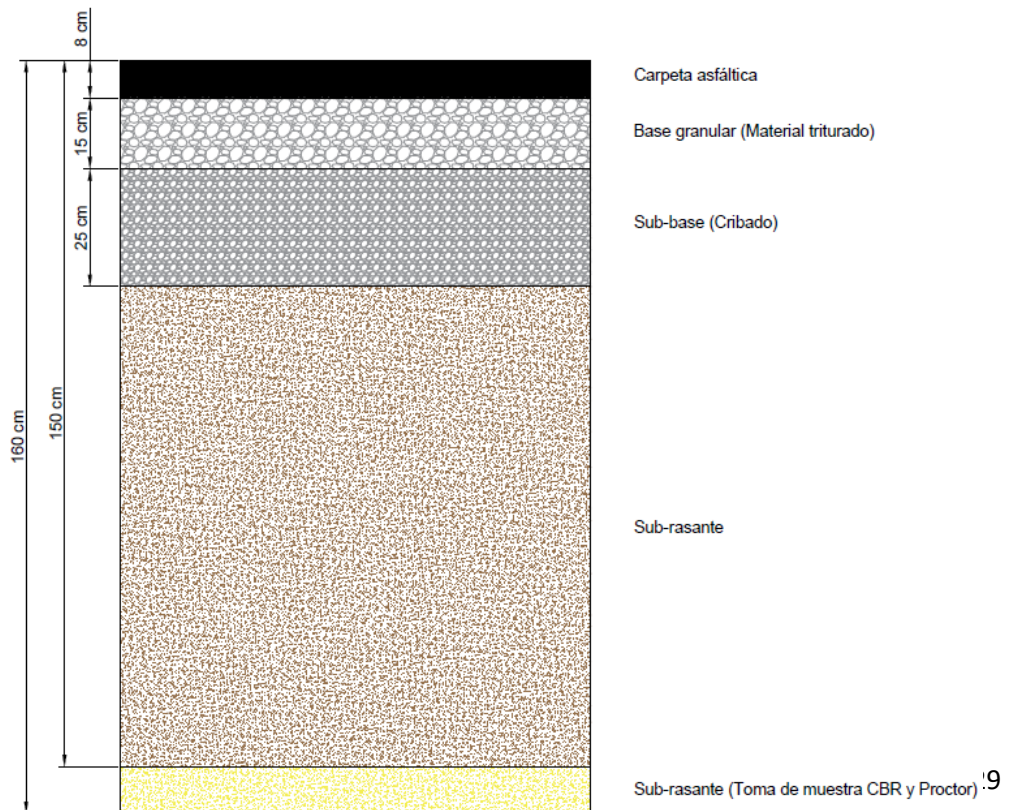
Plano detallado de pavimento de lugar de toma de muestra para Proctor y CBR.
